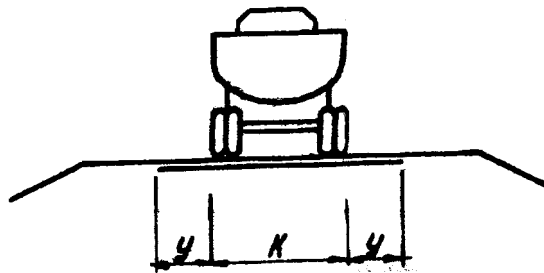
Розрахункова схема руху на дорозі з однією смугою.
